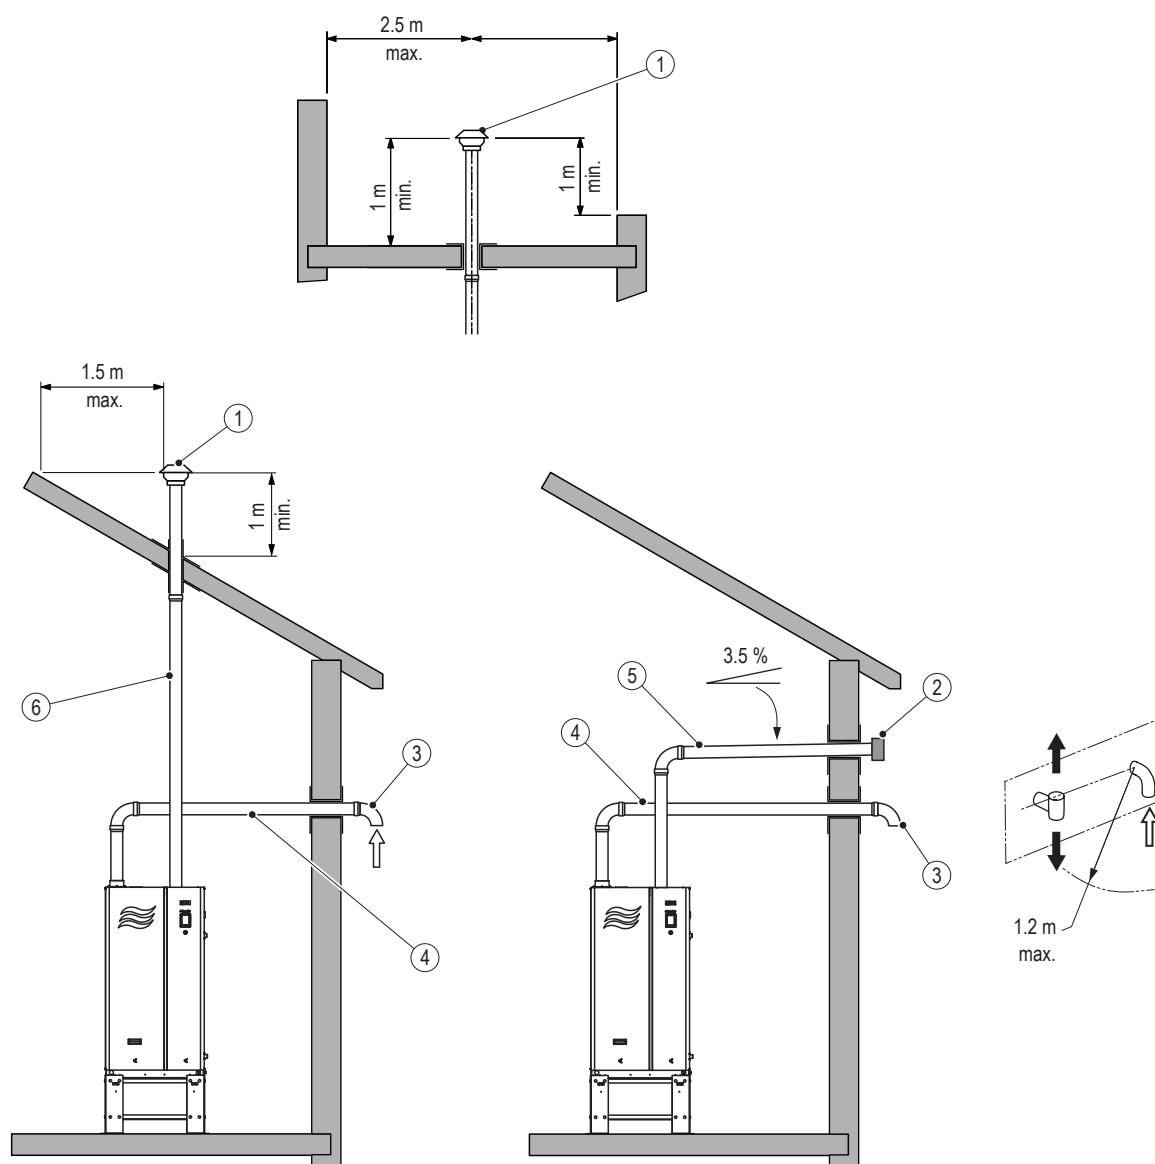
Rookgassysteem type C53 voor gesloten verbrandingsinstallaties
